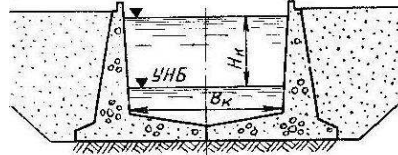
Железобетонная камера шлюза без продольных водопроводных галерей с монолитными стенами и разрезным дном
